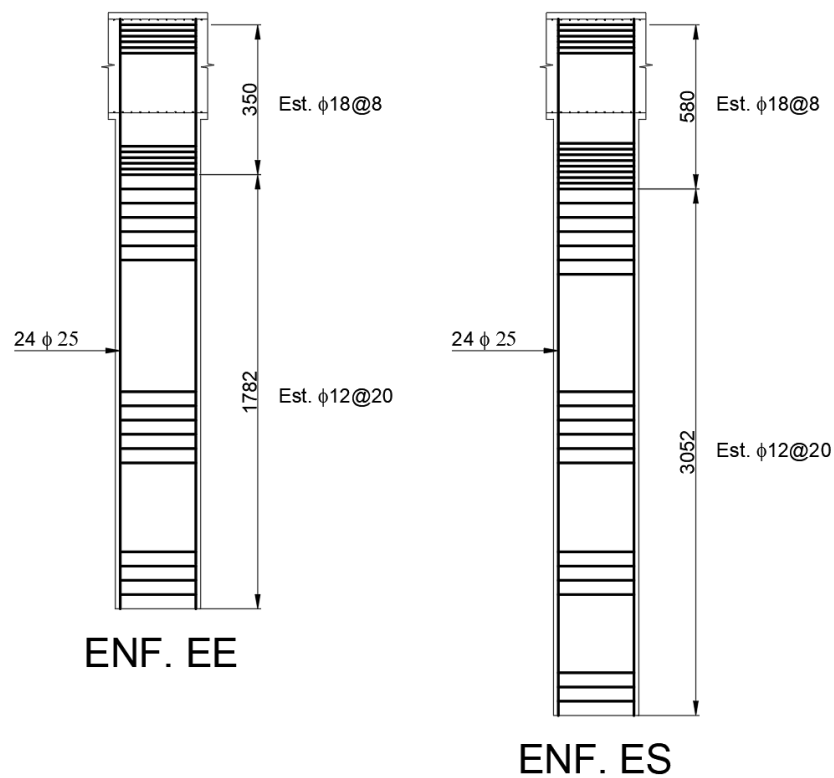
Armadura de diseño pilotes estribos (dimensiones en cm).
